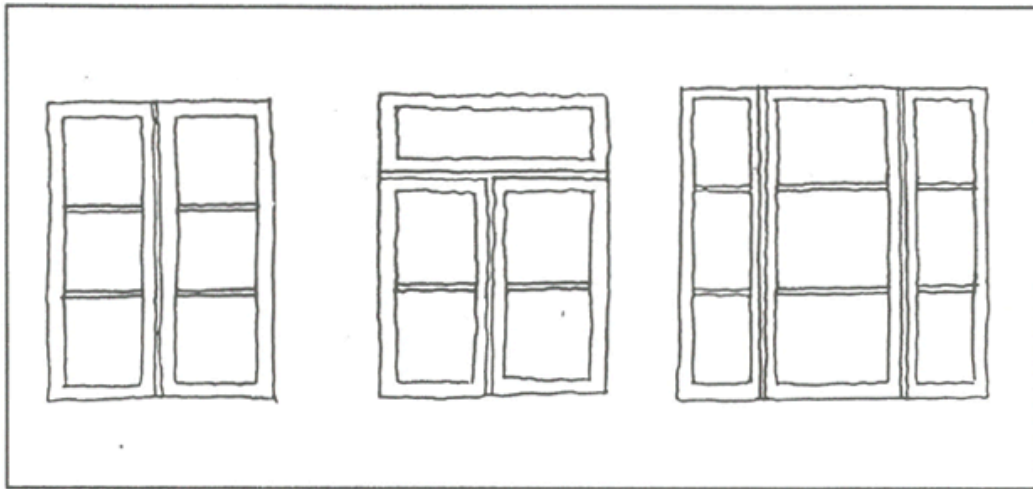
Facadevinduer: Køkkenvindue på 1.sal, køkkenvindue i stueetagen, ventilationsvindue.
